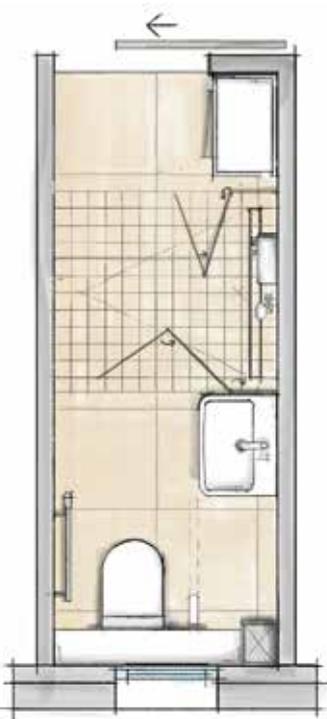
Umbauvariante 5 – Schlauchbad mit Assistenz an Waschtisch und Toilette (Grundriss: DLW)
